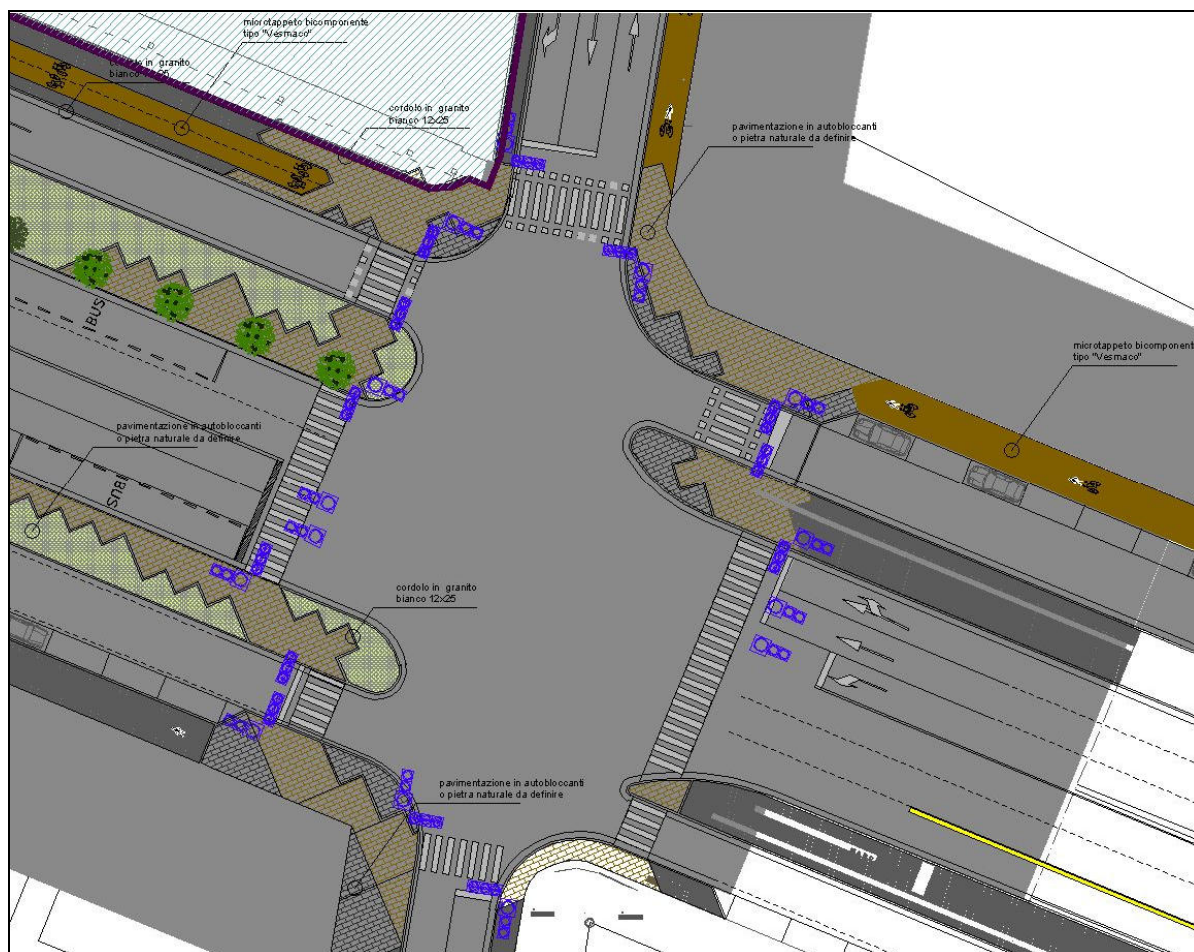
Planimetria di progetto asse corso Bramante – dettaglio intersezione con via G. Bruno
